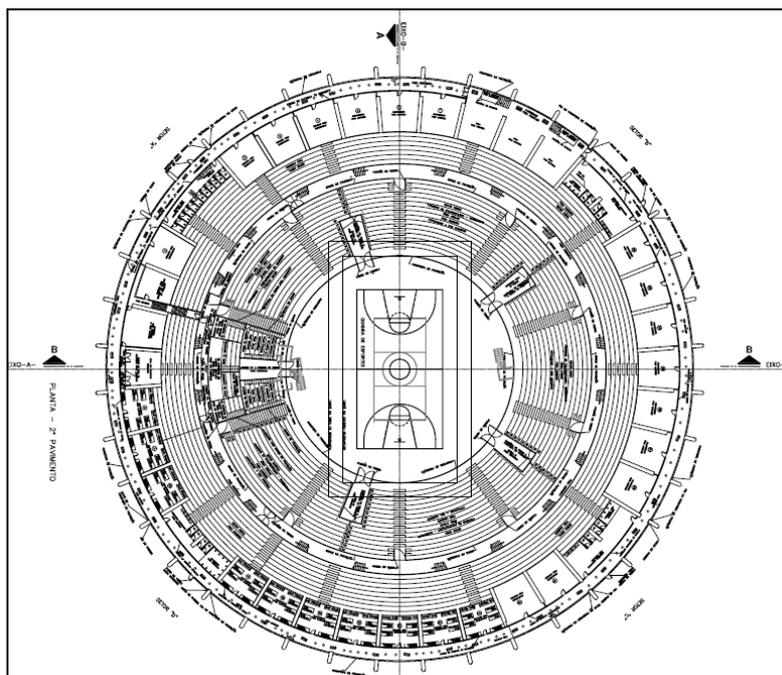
Planta Baixa – 2º Pavimento (Ginásio Geraldo José de Almeida – Ibirapuera)
